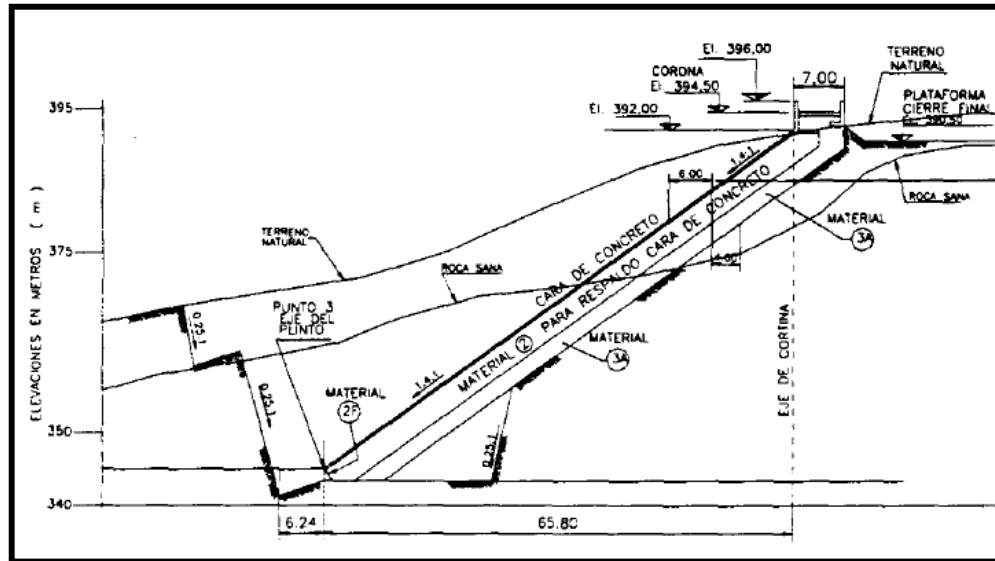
Esquema Sección 3 Unión de Parapeto con cara de concreto A-A
